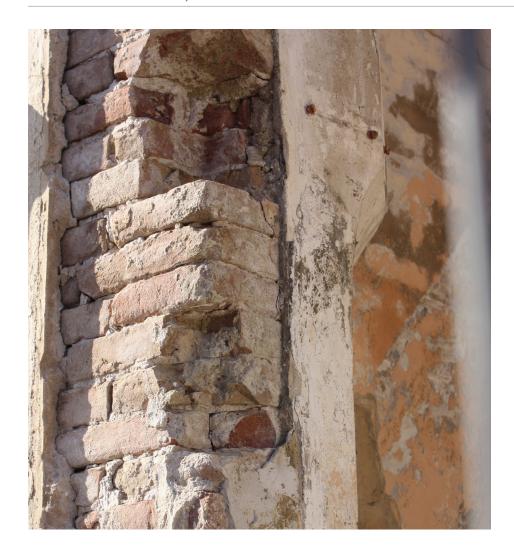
Detalle muro de fachada principal. (Pastor, R. 2011)
